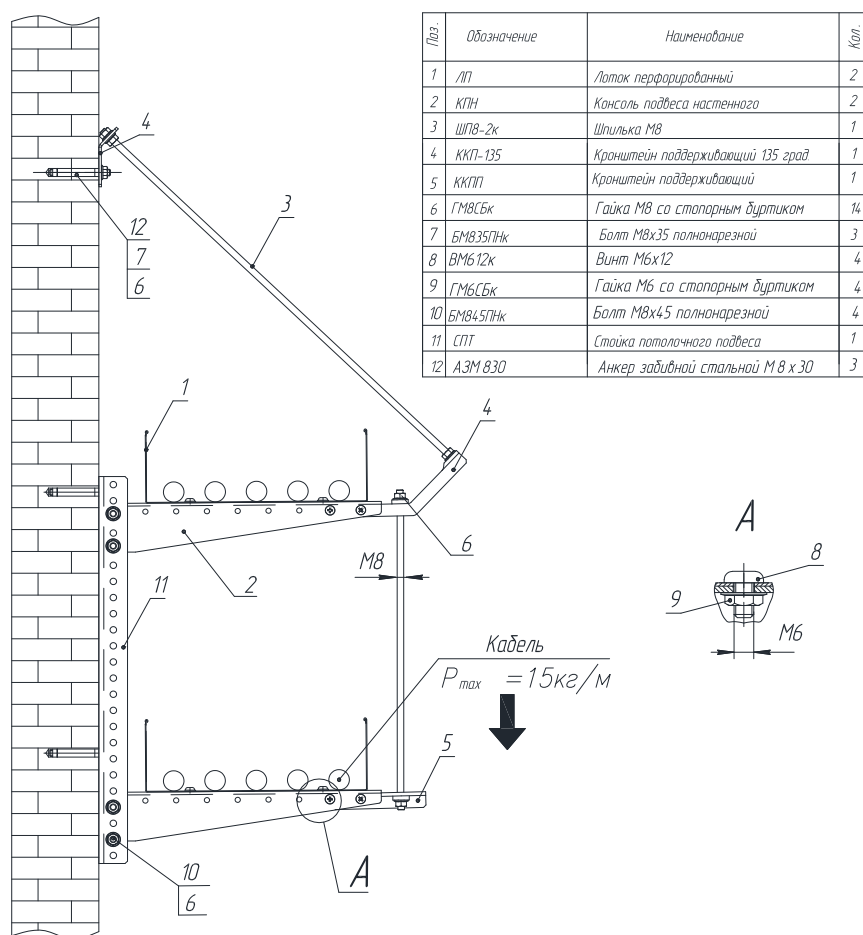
Крепление ОКЛ с помощью поддерживающей шпильки
